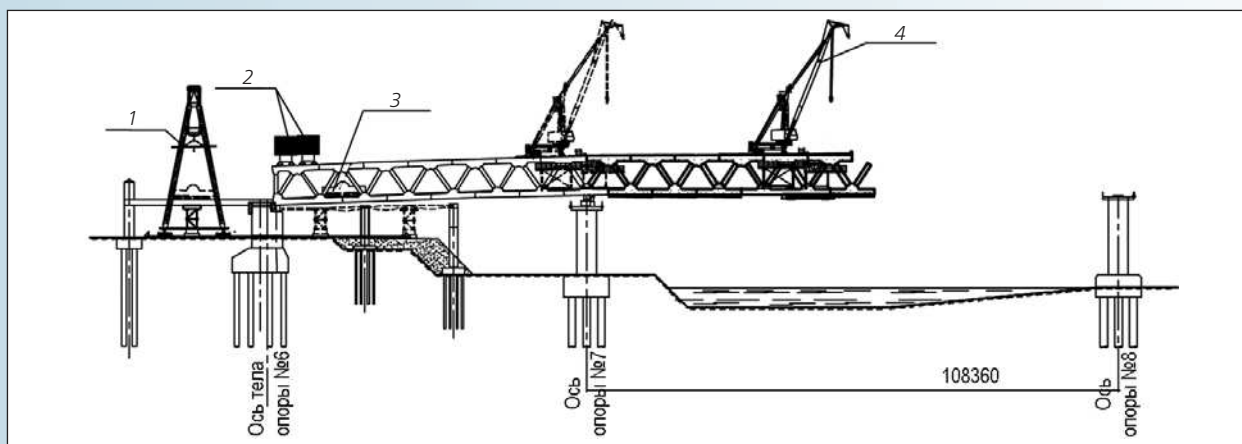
Схема монтажа в пролете 7–8: 1 – кран К-651; 2 – пригруз; 3 – тележка для подачи металлоконструкций; 4 – кран ДК-25-3С
